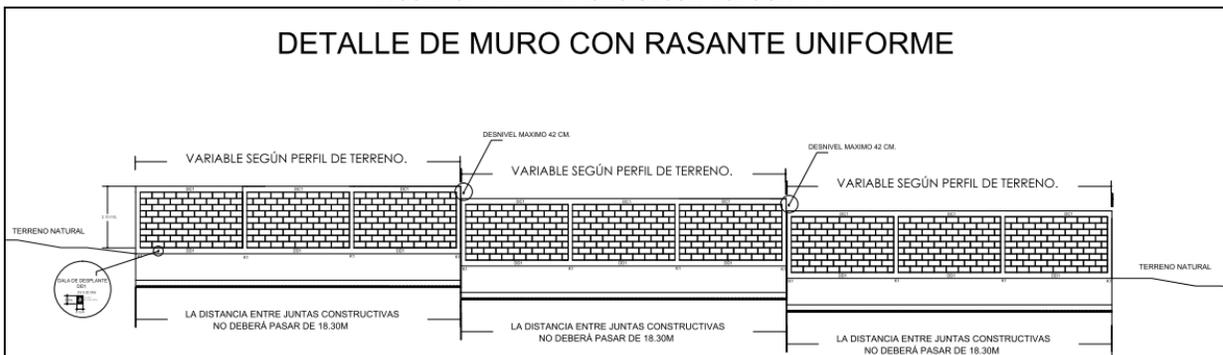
DETALLE MURO SEGÚN TOPOGRAFIA.
